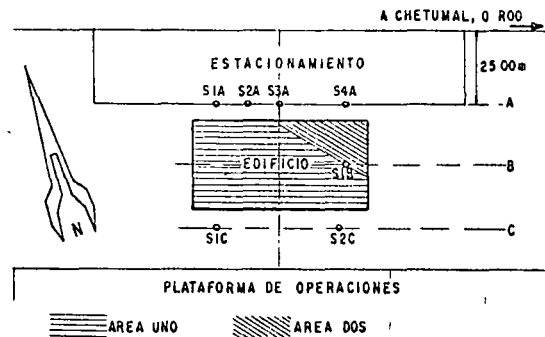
Planta del edificio del sitio 2, donde se localizan los pozos de exploración.
